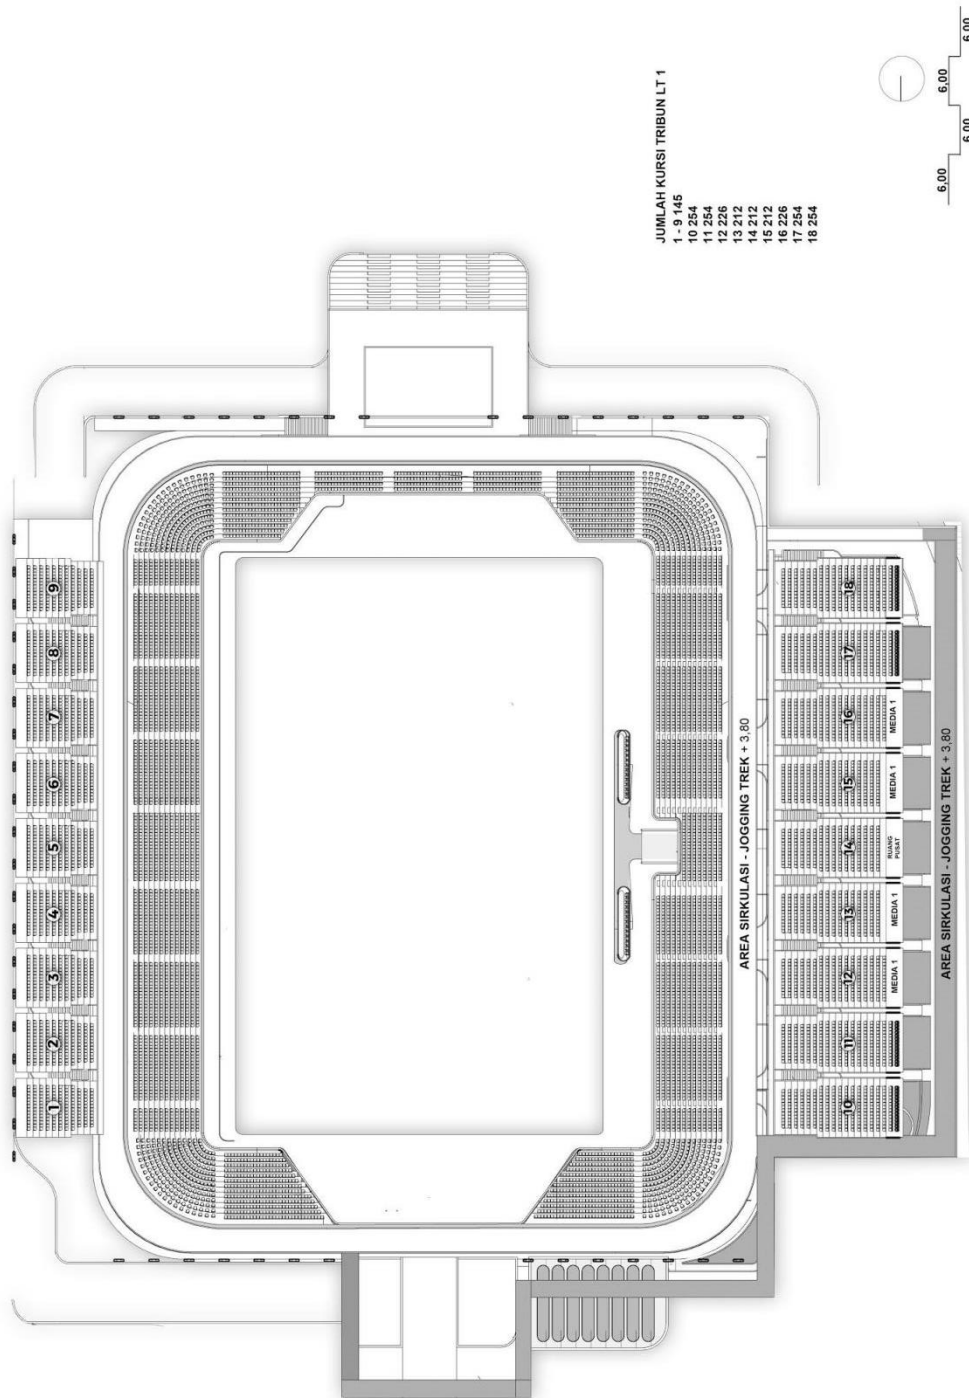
Detail Denah LT 1 - Tribun Area Barat
